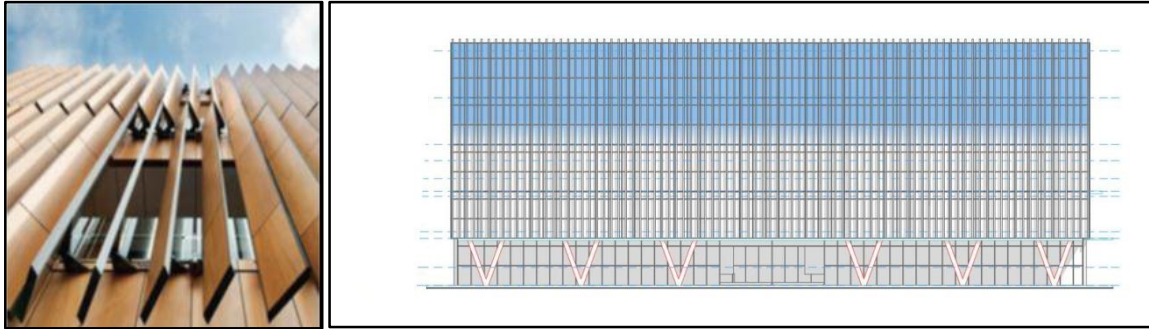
brise soleil vertical Figure 93:brise soleil sur la façade est (Source : auteur)
